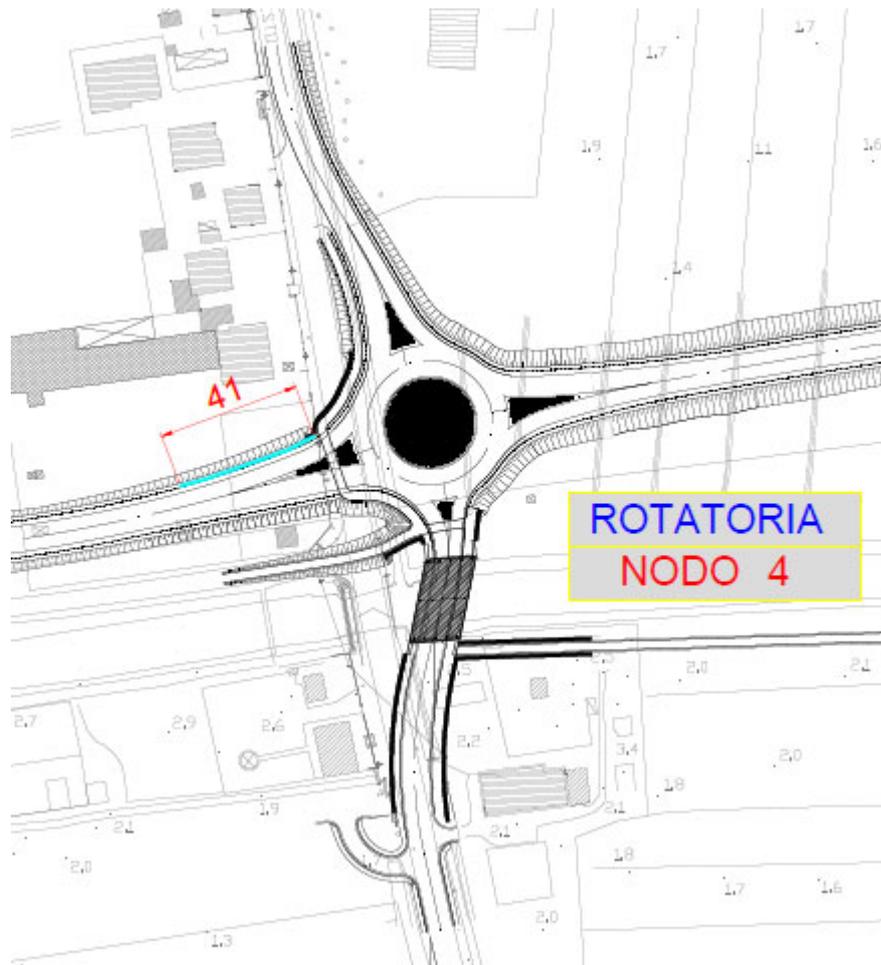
Planimetria barriere acustiche nodo 4 (lotto 3-5)
